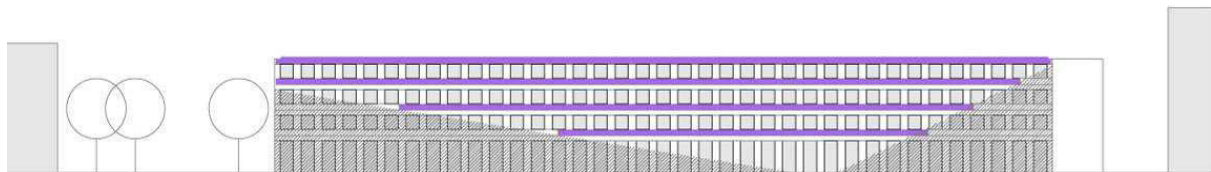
Bsp. Fassade mit Beschattung und PV Flächen
